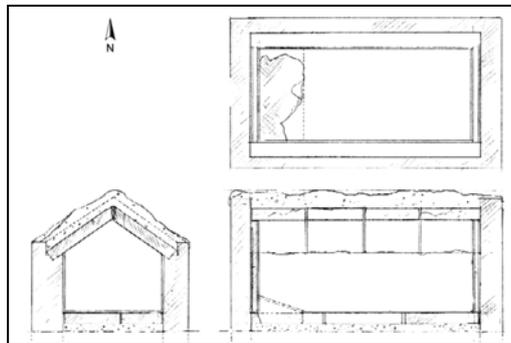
Grundriss und Schnitte des Grabes
